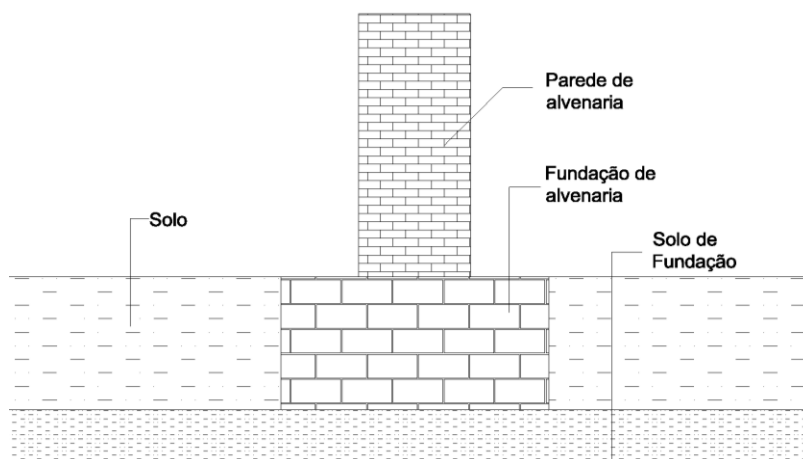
Desenho esquemático de fundações contínuas em alvenaria de pedra
